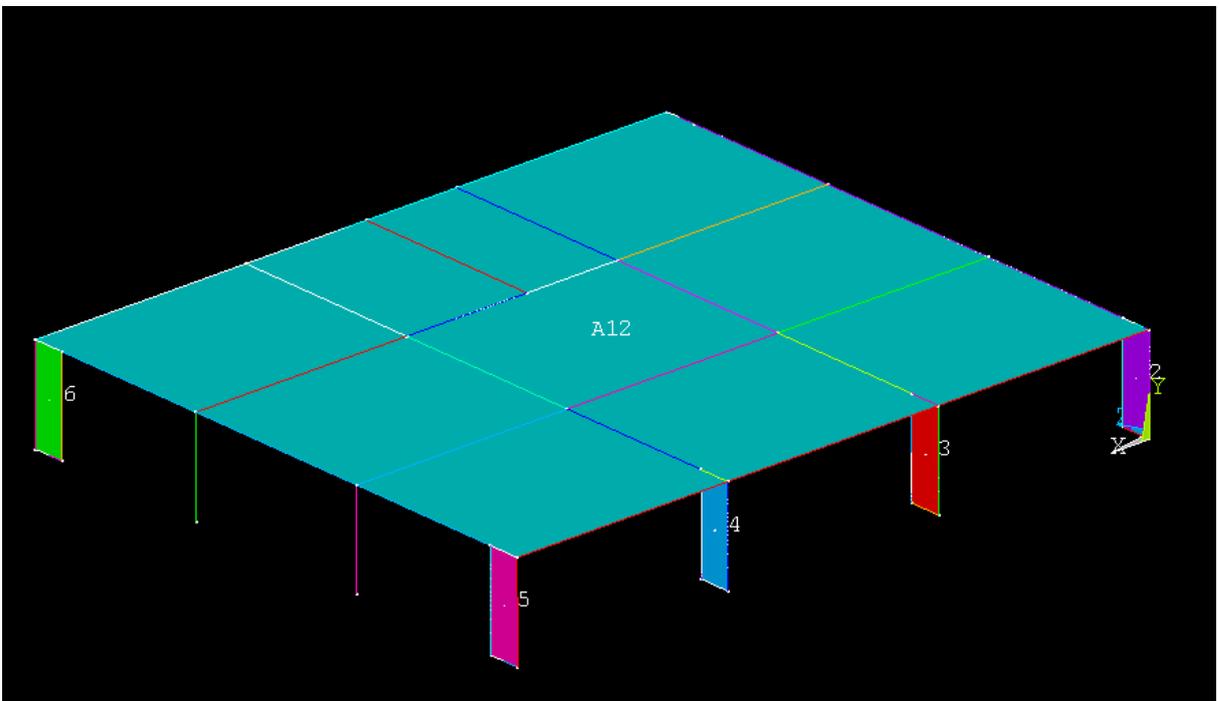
Построение поверхности плиты перекрытия 1-го этажа
